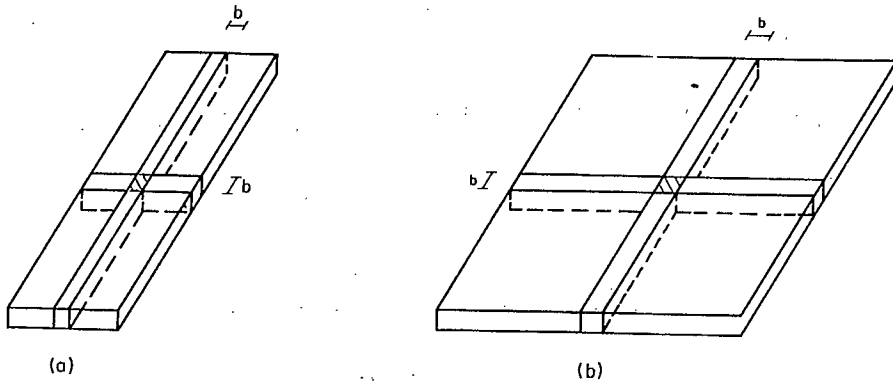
La flexion bi-directionnelle d'une dalle
